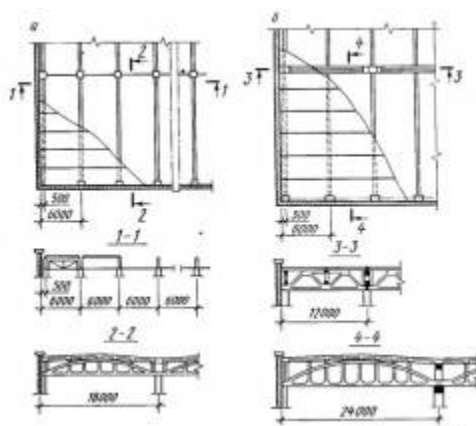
Конструктивные схемы одноэтажного промышленного здания: а – с шагом колонн 6 м; б – то же, с подстропильными конструкциями, при шаге крайних колонн 6 м
